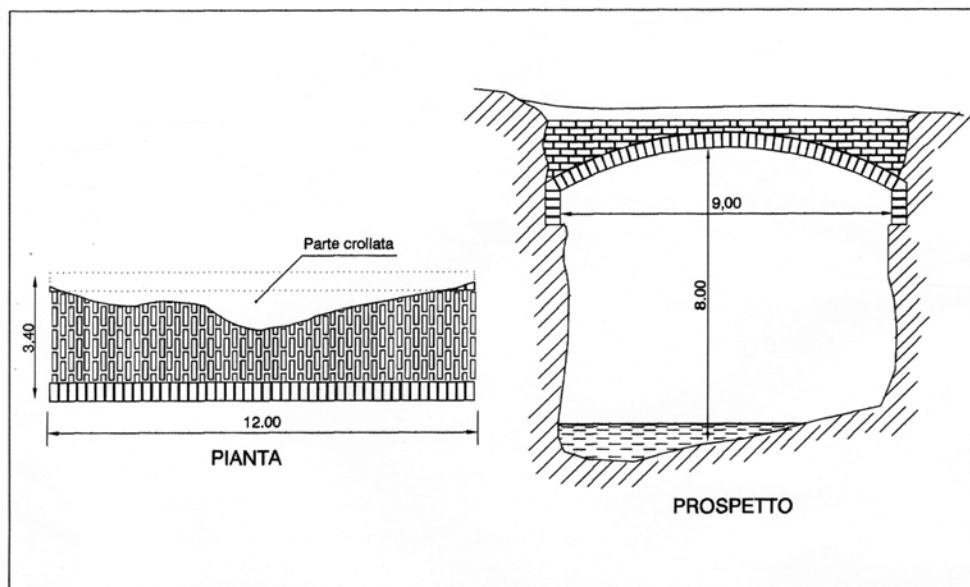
Pianta e prospetto del ponte (scala 1:100).
